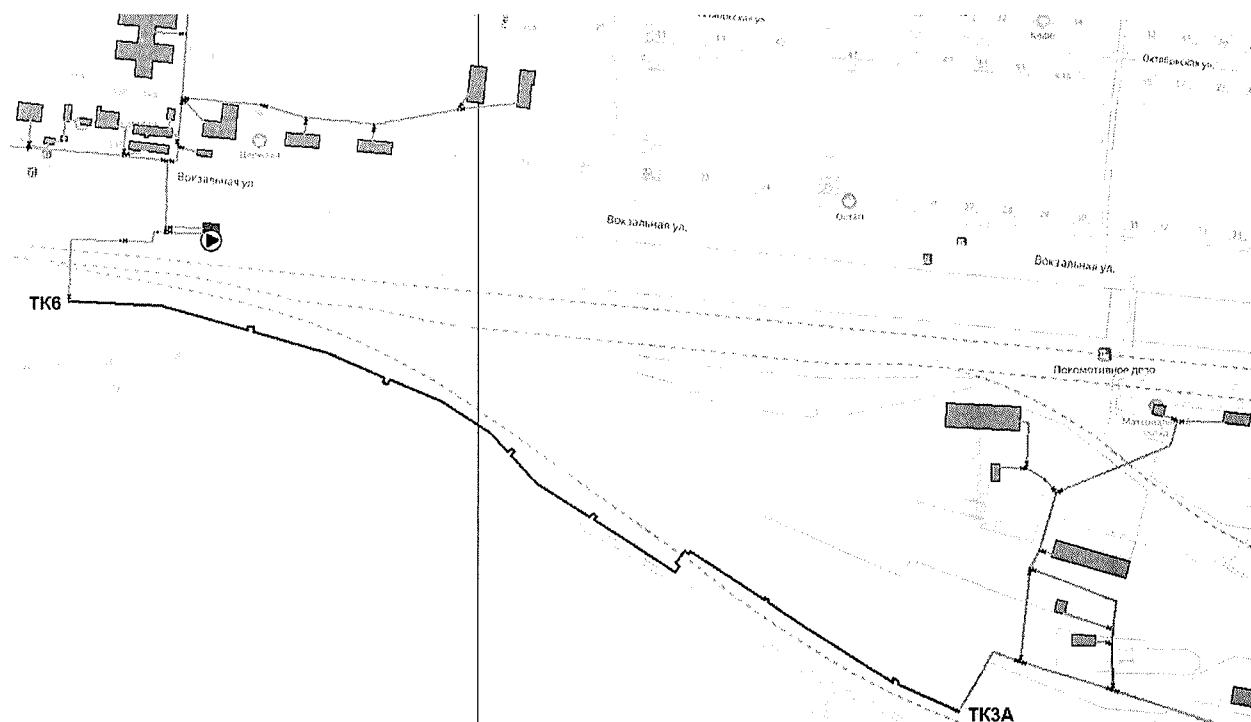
Трубопроводы, перекрытые для проведения ремонтных работ.
